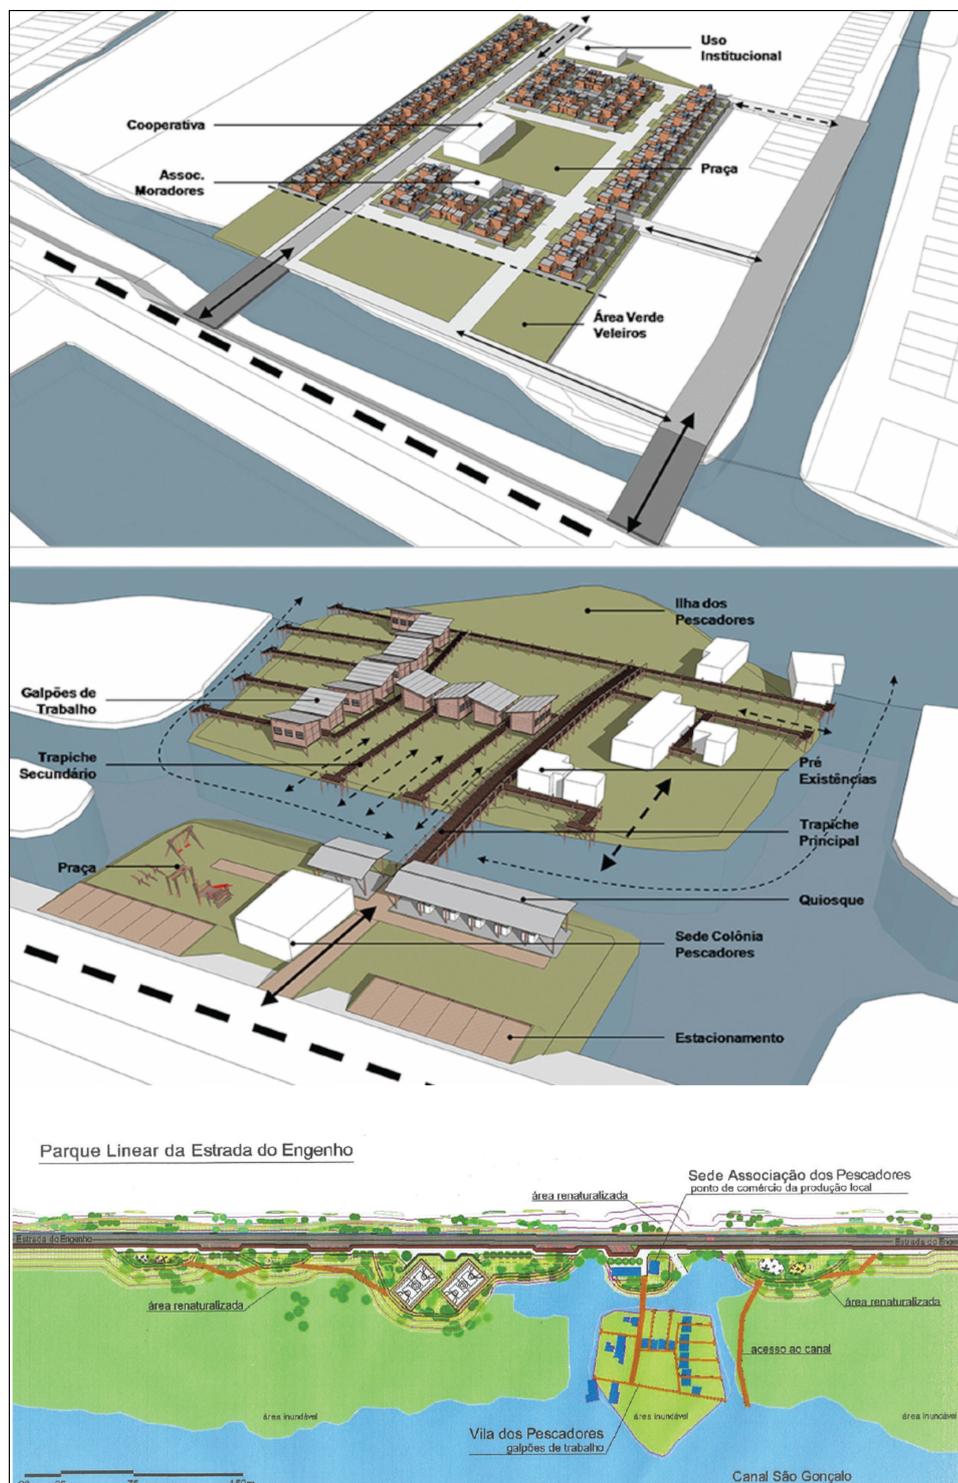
Projeto do loteamento da Ilha dos Pescadores e do parque da Estrada do Engenho.
